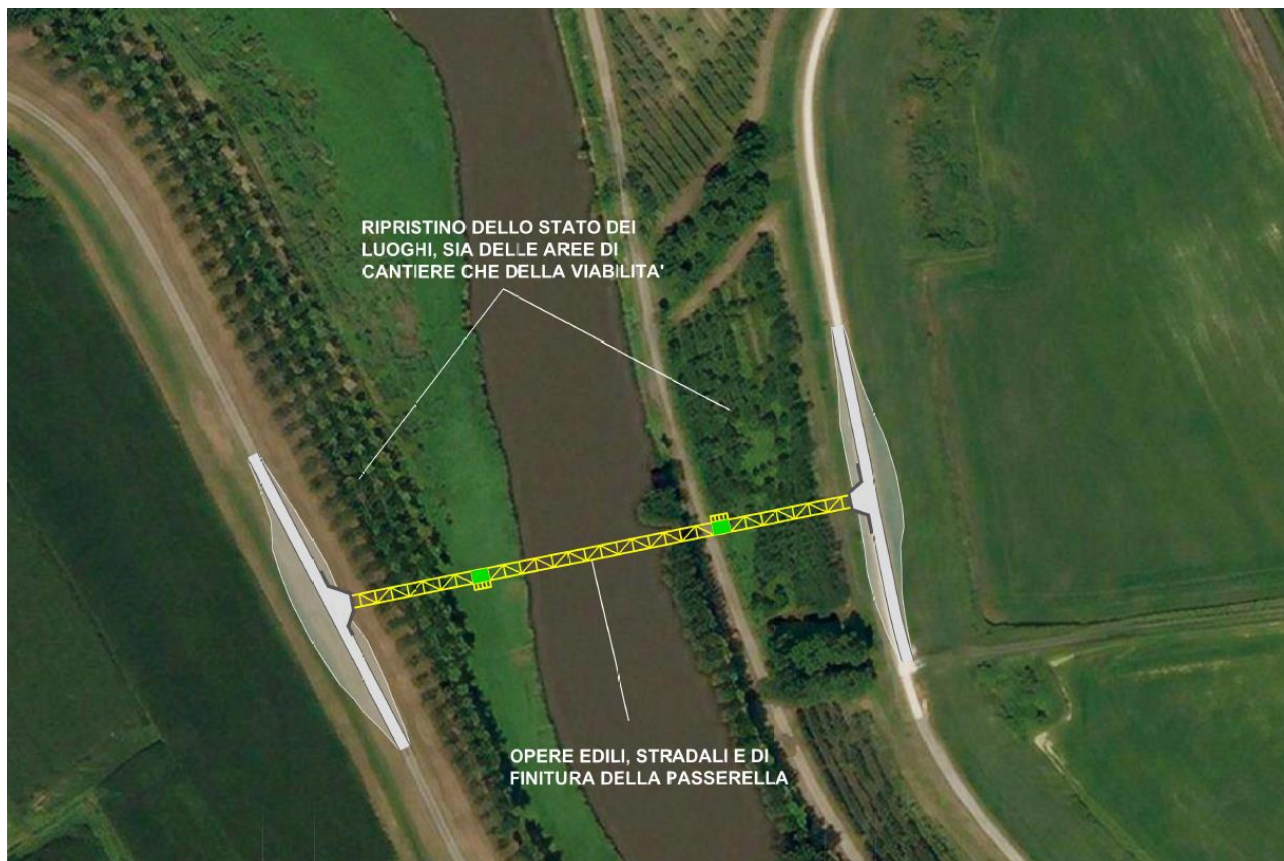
Ponte Lambrinia – ripristino stato dei luoghi, opere edili di finitura e montaggio parapetto.
